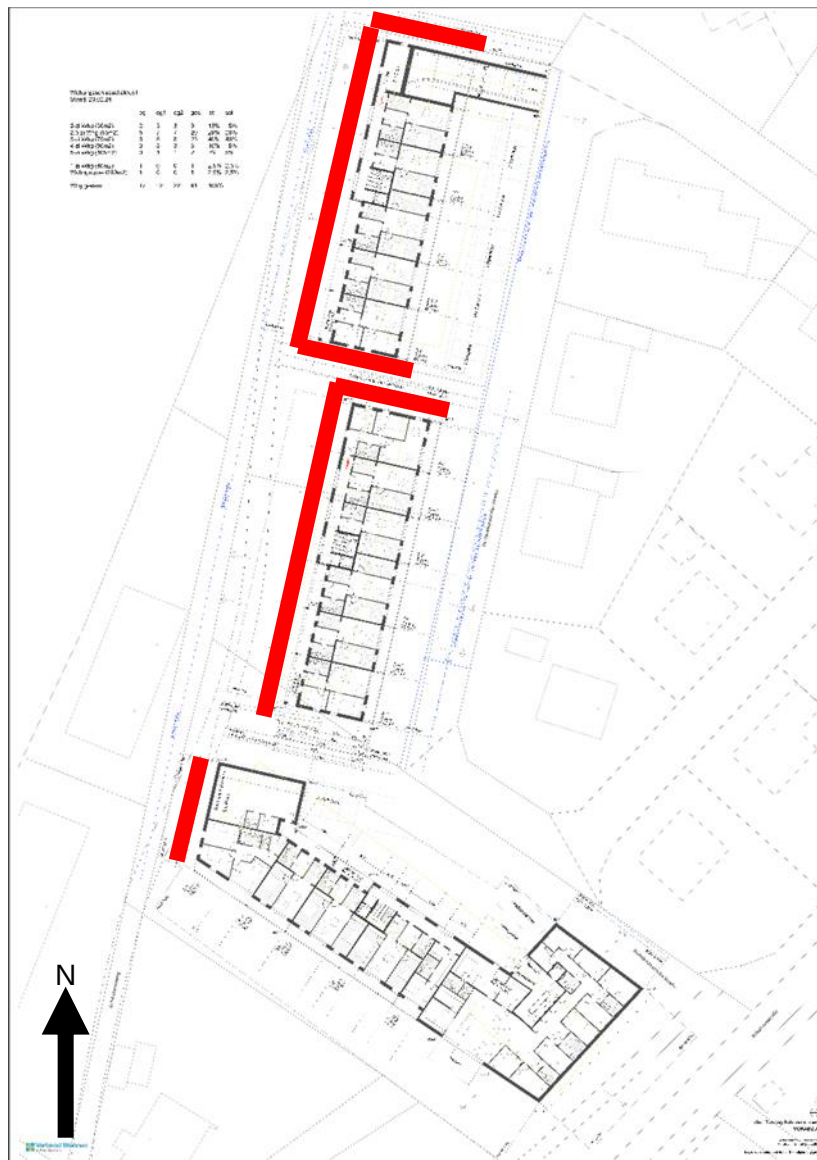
Fassadenkennzeichnung für den Bebauungsplan.
